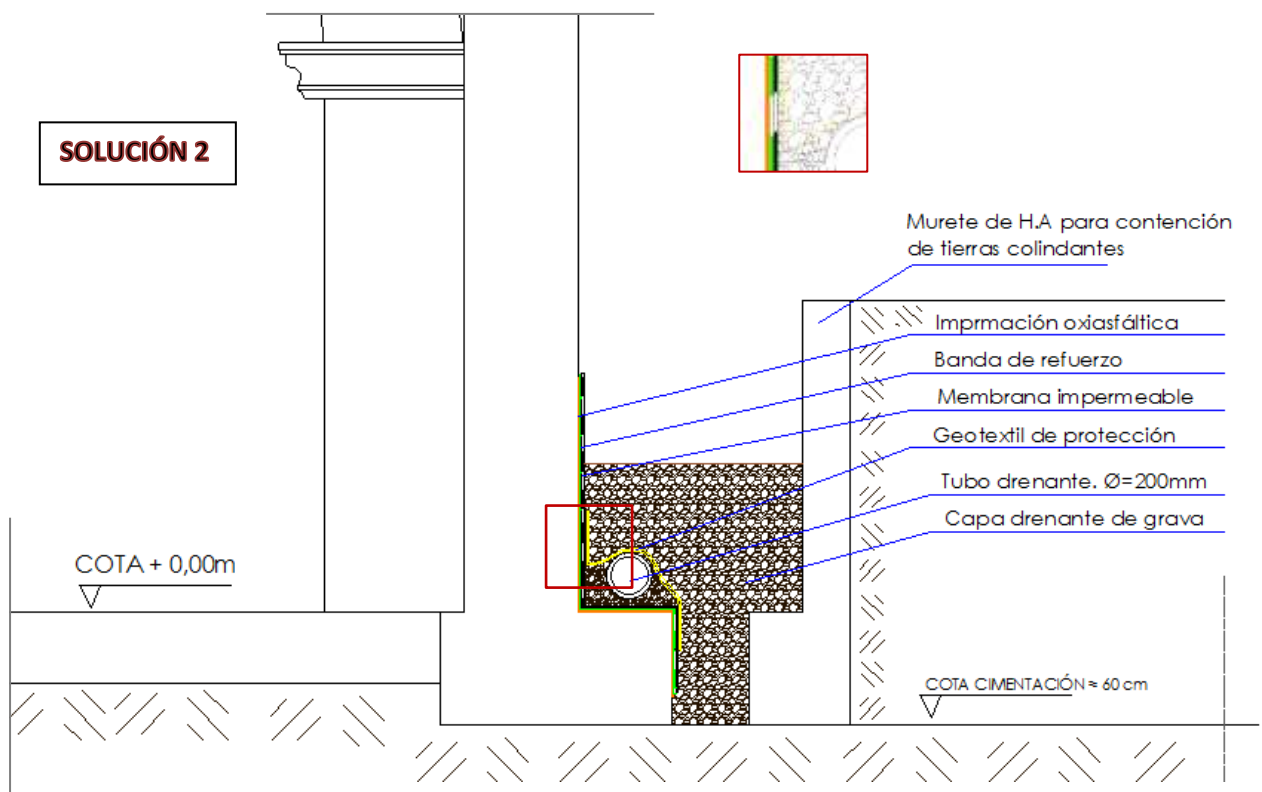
Detalle constructivo drenaje del terreno en alzado posterior.
